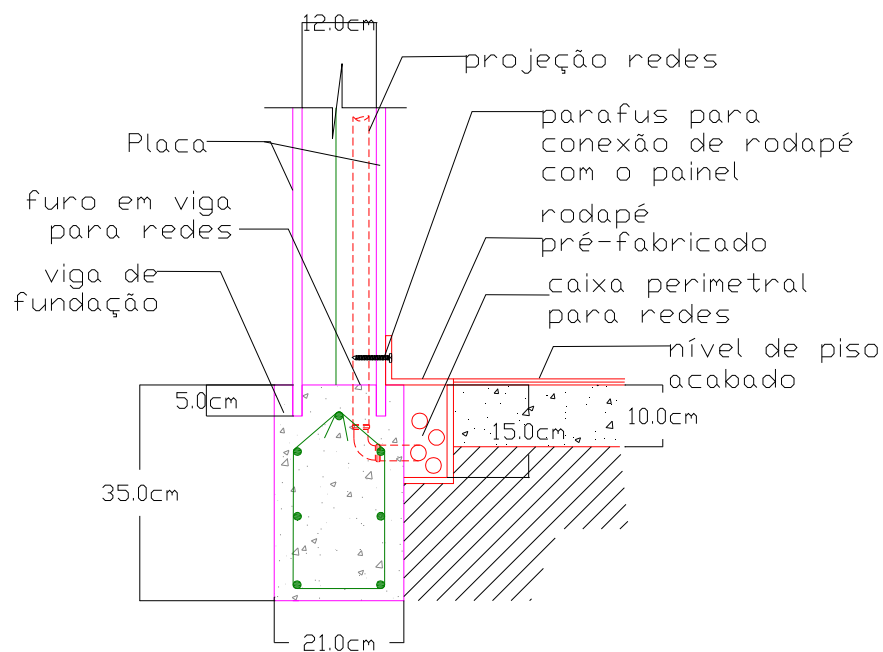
Detalhe de viga de fundação, comum para todas as alternativas.
